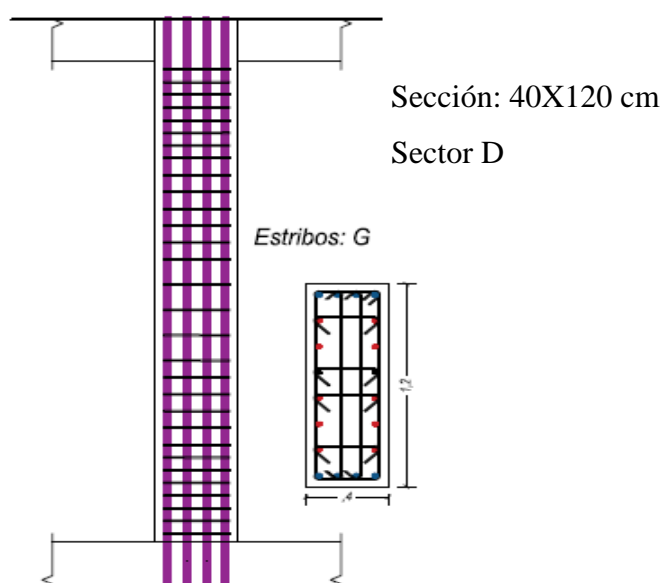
Detalle de Columna en Base Aislada (D)
